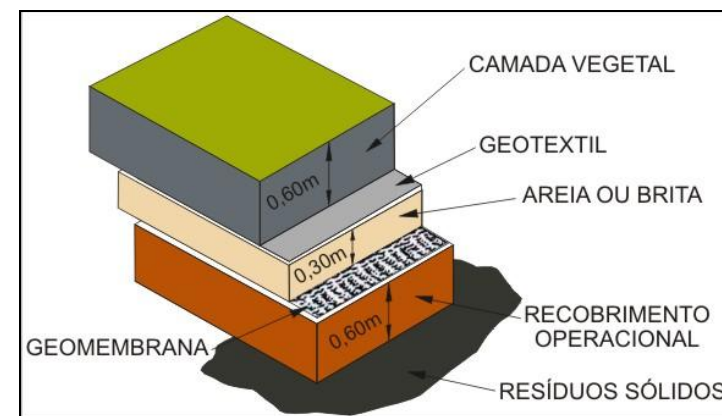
Esquema da Impermeabilização Superior das Bacias Industriais
